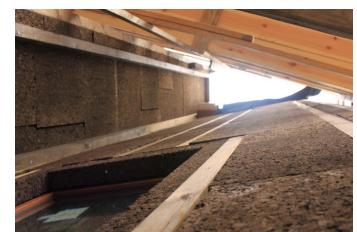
Paneles de corcho en fachada. Rastrelado en capa exterior para anclaje de fachada ventilada. (<http://casaentreencinas.blogspot.com.es>)
